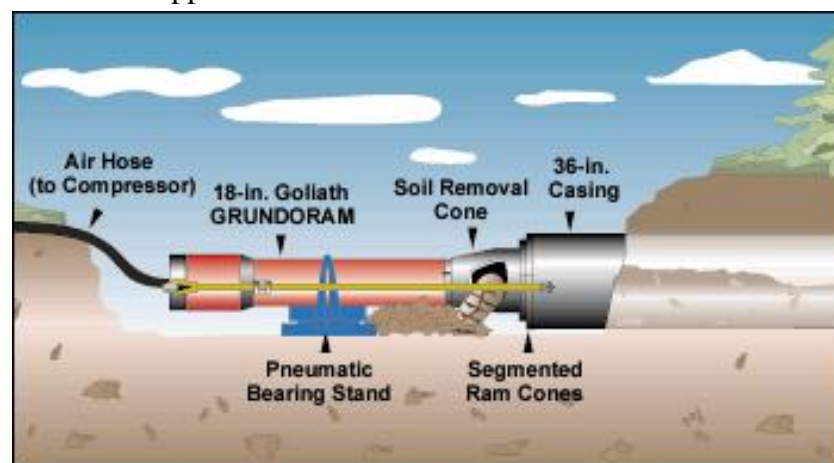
un schéma d'une opération du pipe-ramming (*Typical pipe ram set up. For the Los Alamos job, the DH Underground crew was able to install 250 feet (78m) of 36-inch casing*)
